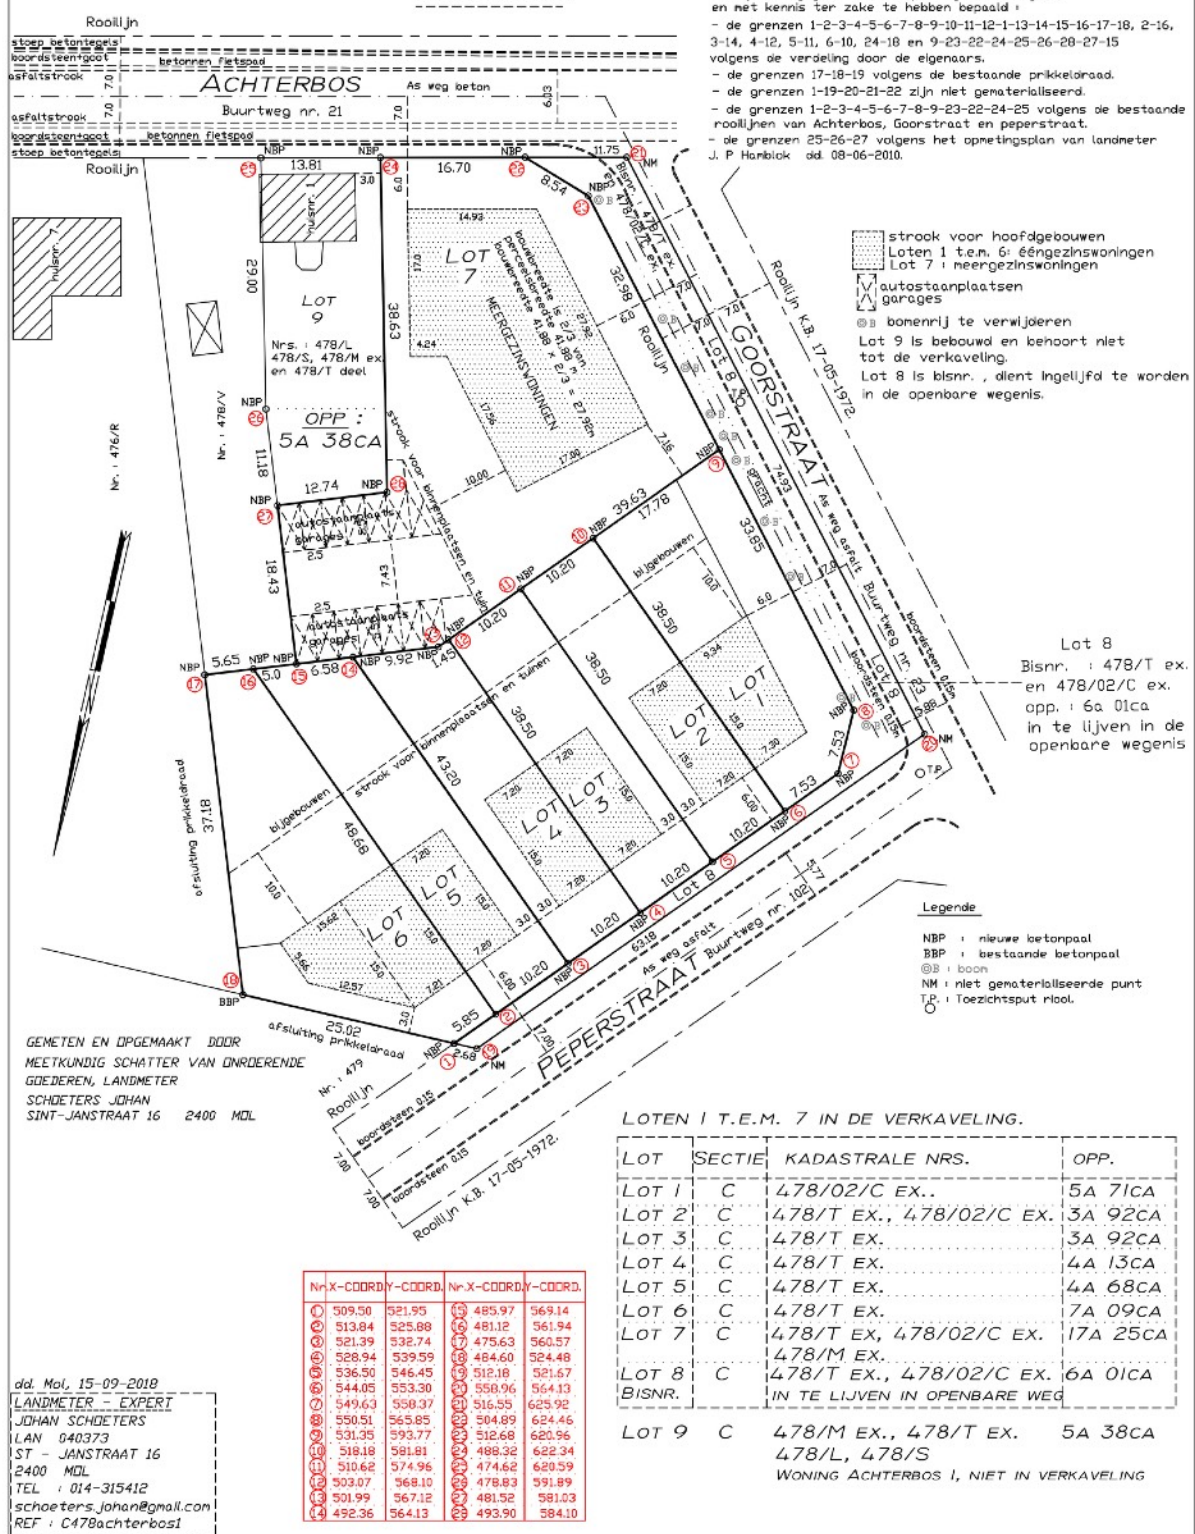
Verkavelingsplan. © Johan Schoeters 15-09-2018
